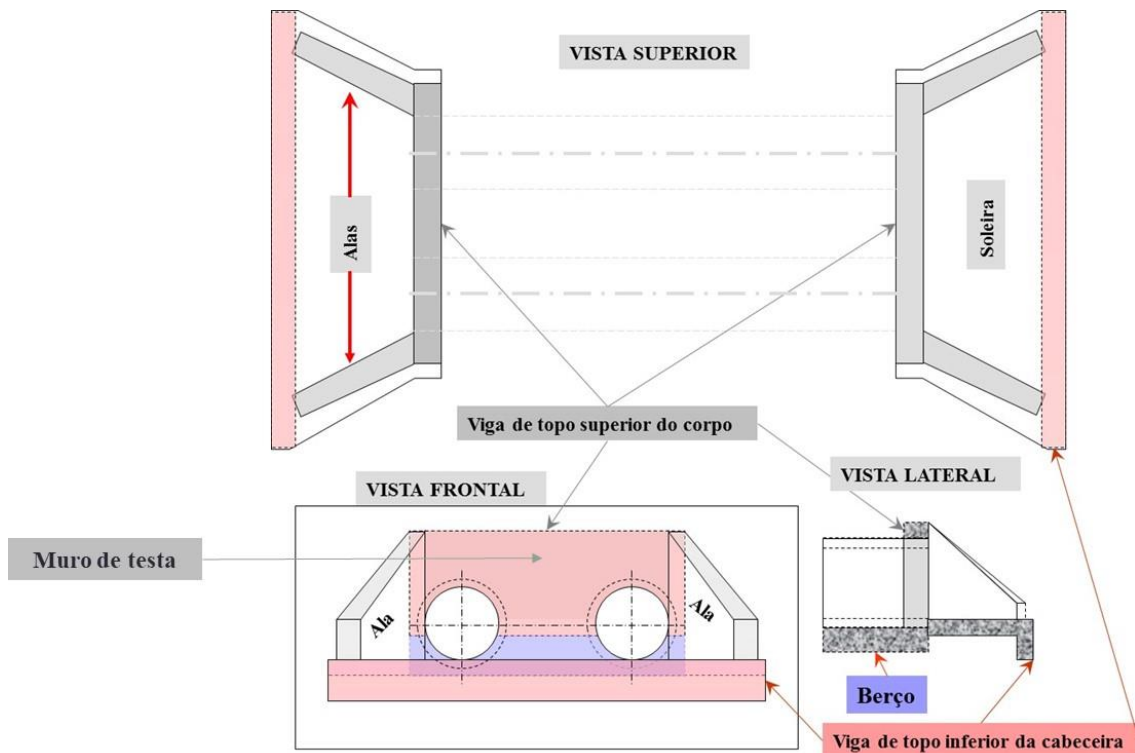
Croqui com detalhamento das partes constituintes da boca de um bueiro.
